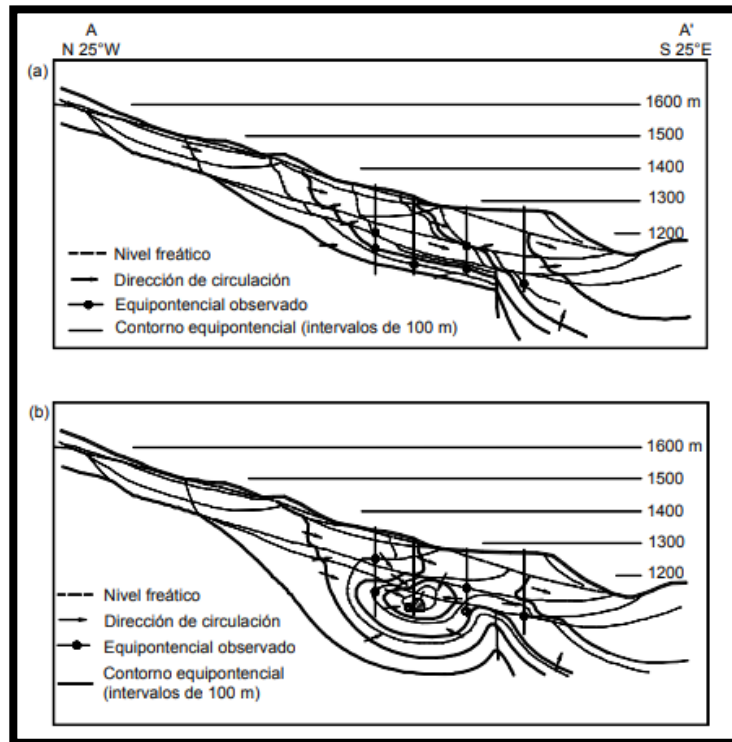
Efecto de una galería de drenaje sobre las líneas piezometricas en un gran deslizamiento
